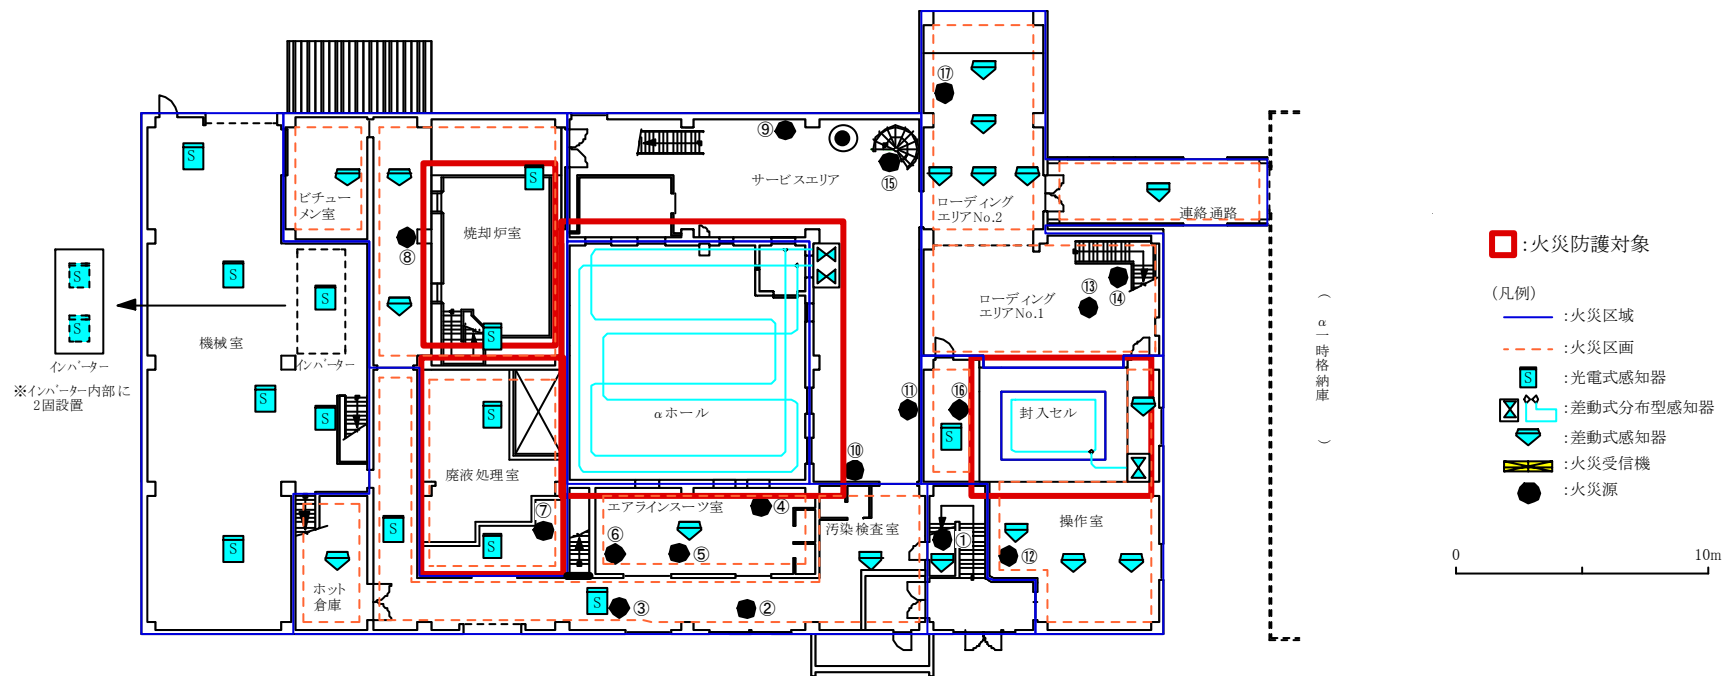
β・γ 固体処理棟IV 1階平面図及び可燃物配置図
